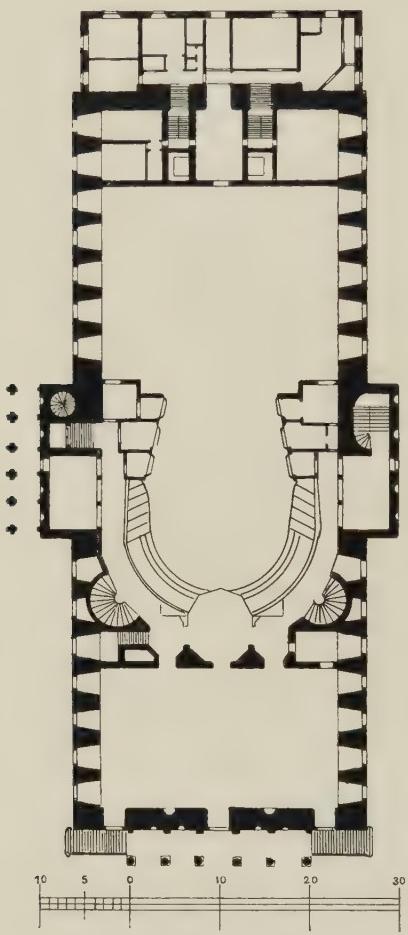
Opernhaus in Berlin Grundriss
